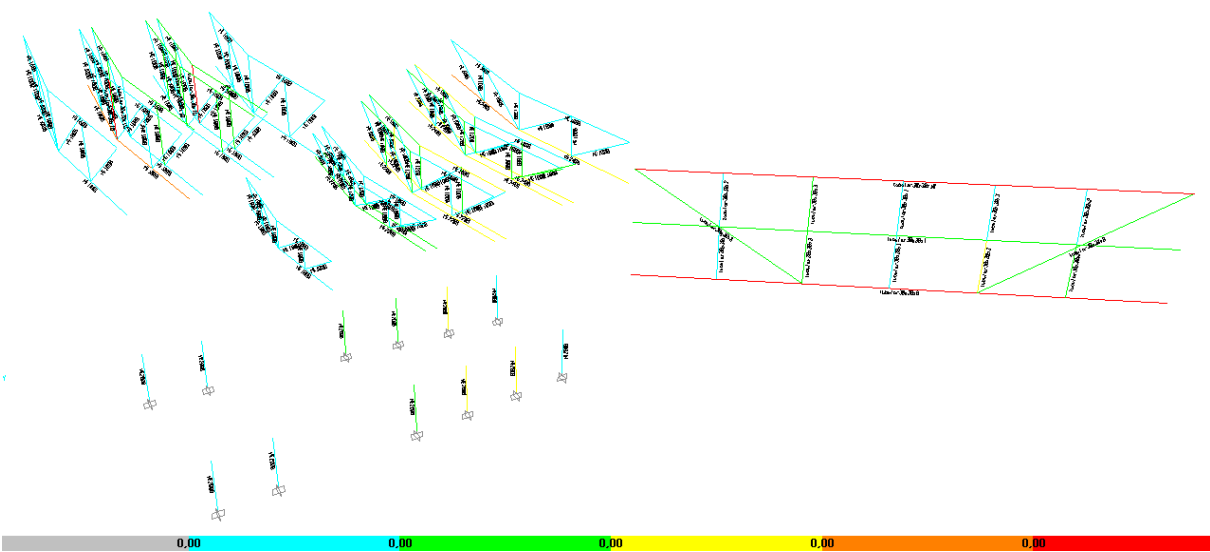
ANÁLISIS DE LAS BARRAS DE LA ESTRUCTURA.
